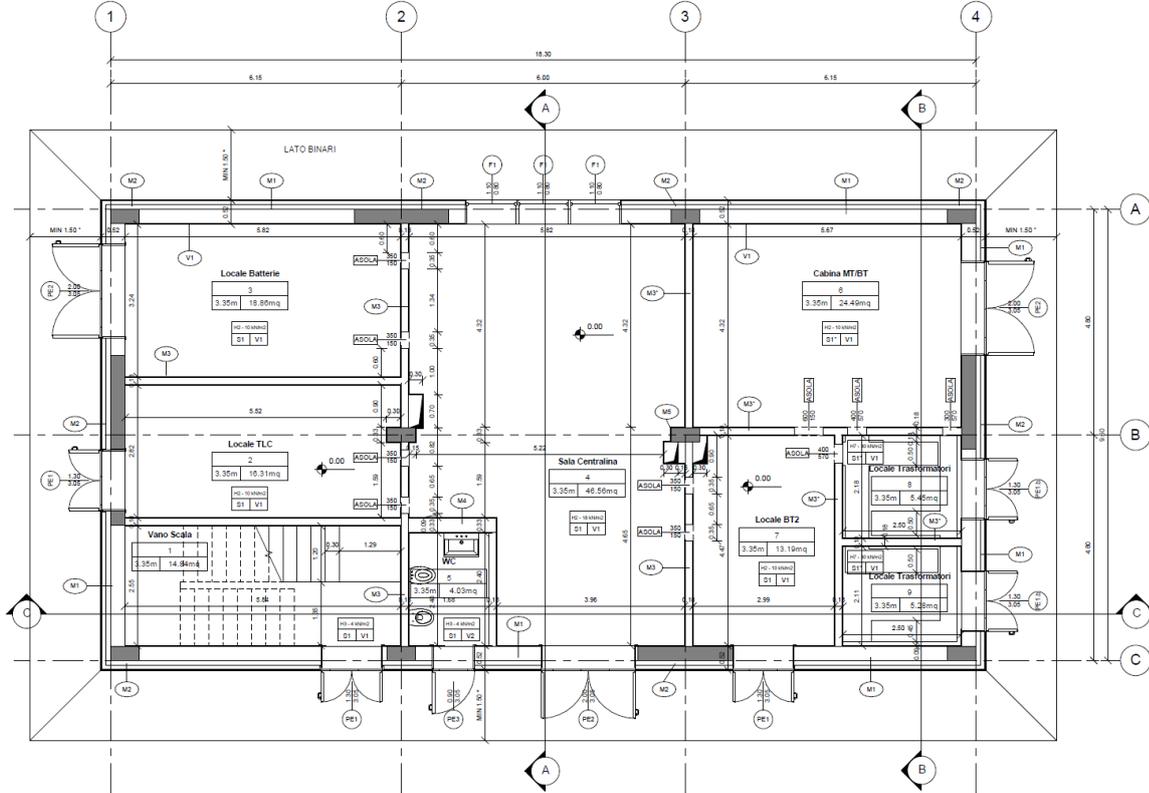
PPM Pieve Emanuele – Pianta Architettonica Piano Terra
